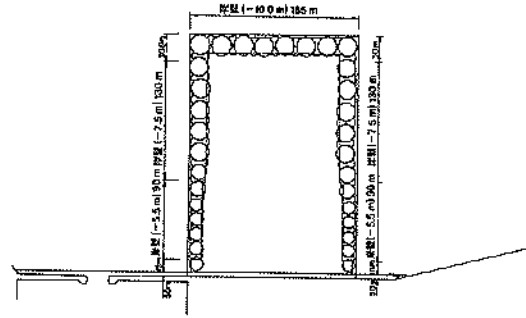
(a) 万代埠頭平面図 (函館港)
